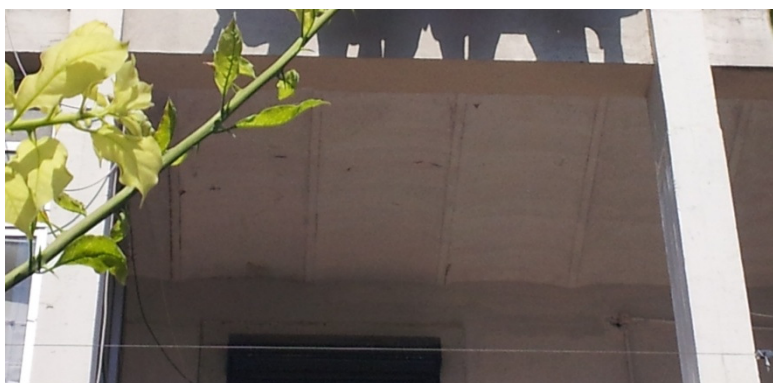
Pórtico de betão armado e pavimento em abobadilhas cerâmicas nas varandas do tardoz
